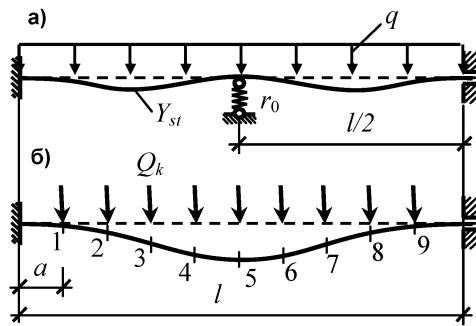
Расчетная схема железобетонной балки до (а) и после (б) обрушения опоры
